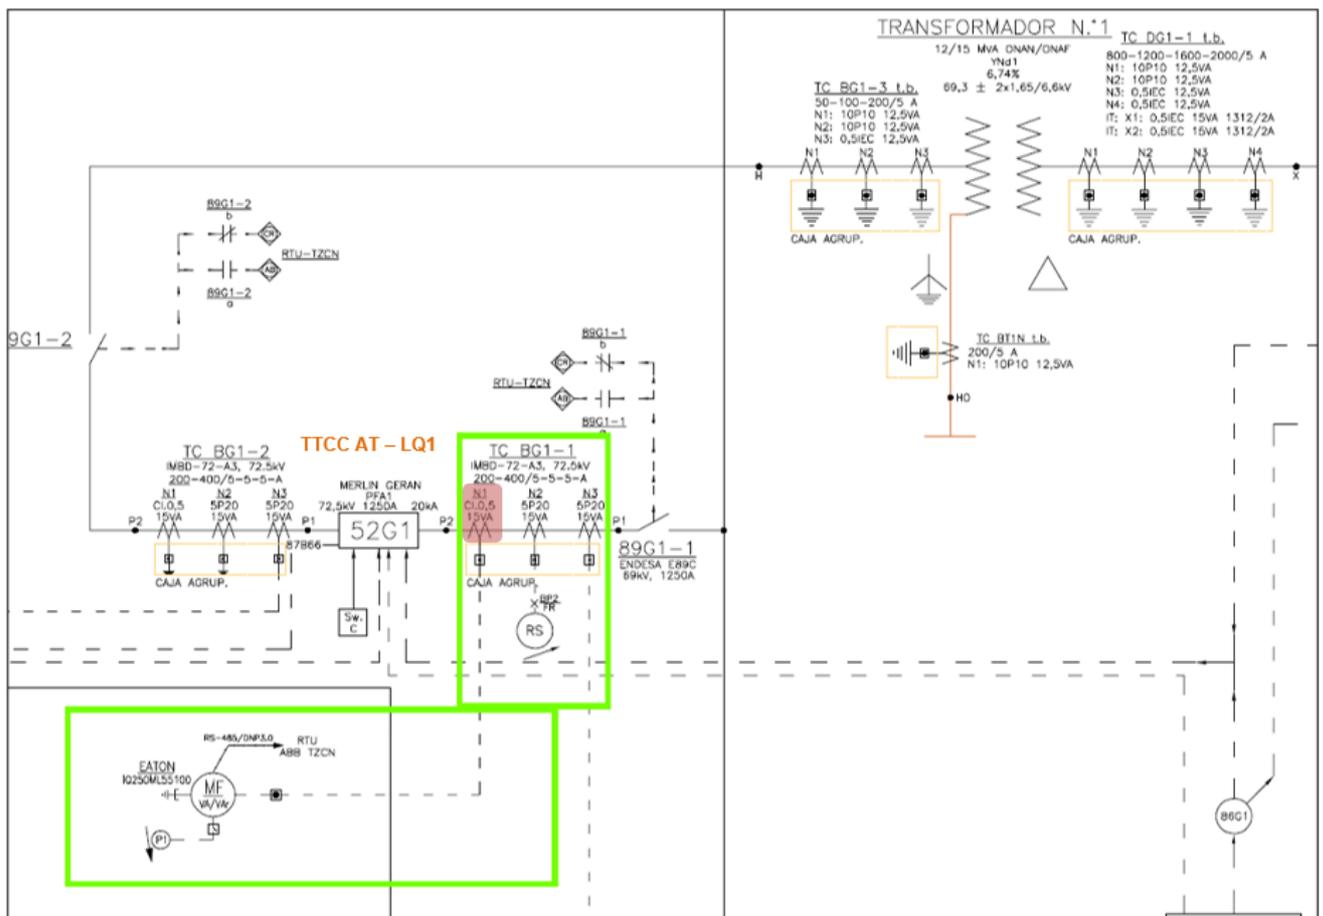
Unilineal de planta esquemático – Salida de Barra 66 kV
